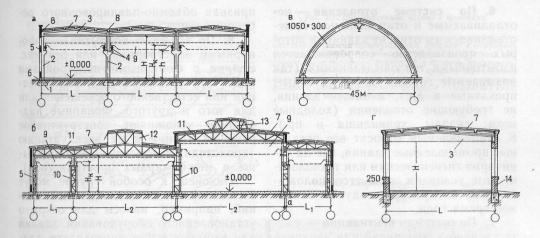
Конструктивные схемы покрытий каркасных промышленных зданий
